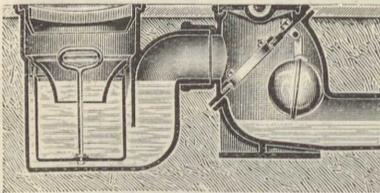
Selbsttätiger Rückstauverschluß in Verbindung mit einem Fußbodeneinlauf.
